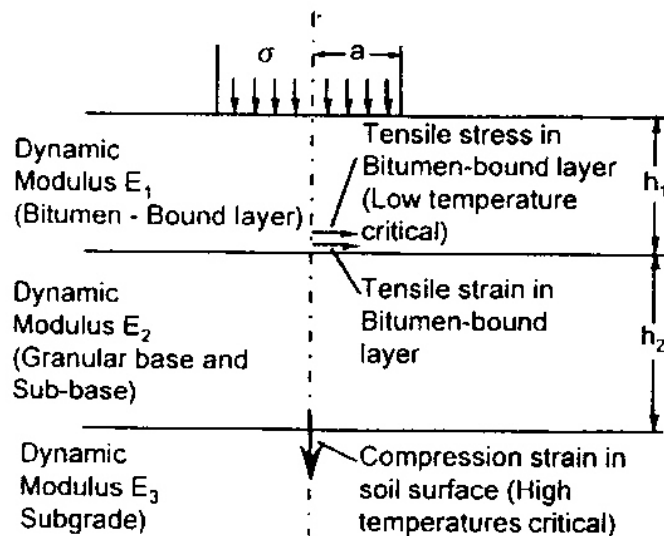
Modello di Dormon per la progettazione delle pavimentazioni
